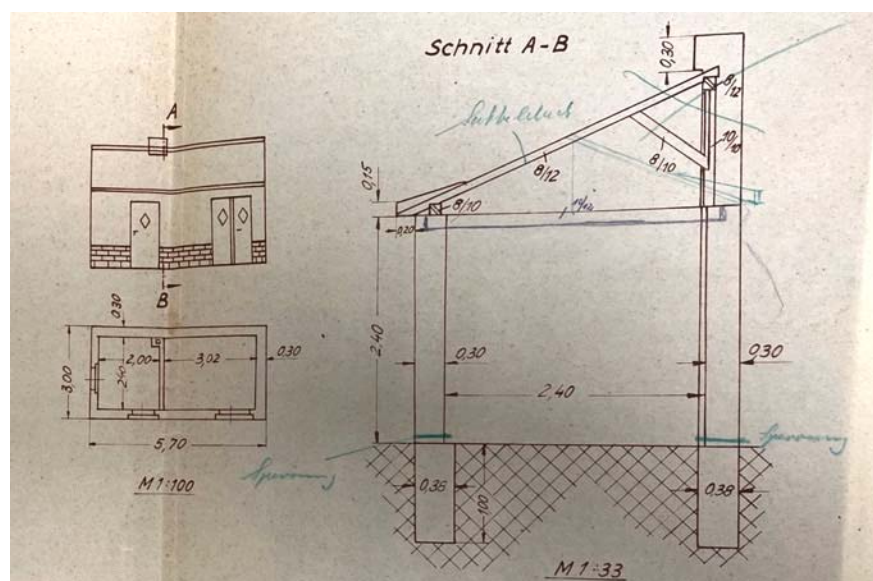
bauzeitlicher Plan zum massiven Schuppen
